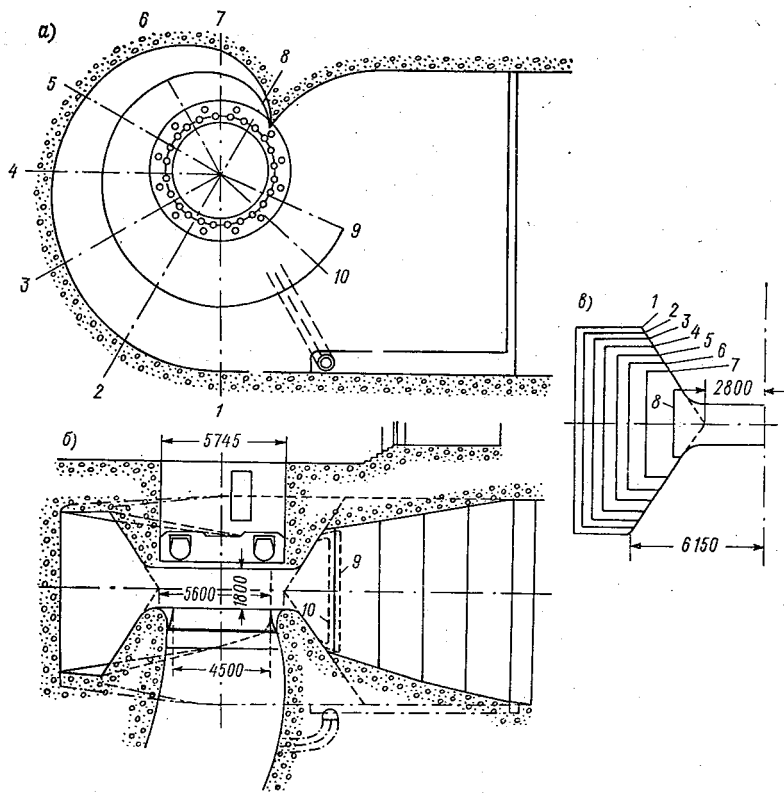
Спиральная турбинная камера из армированного бетона.
